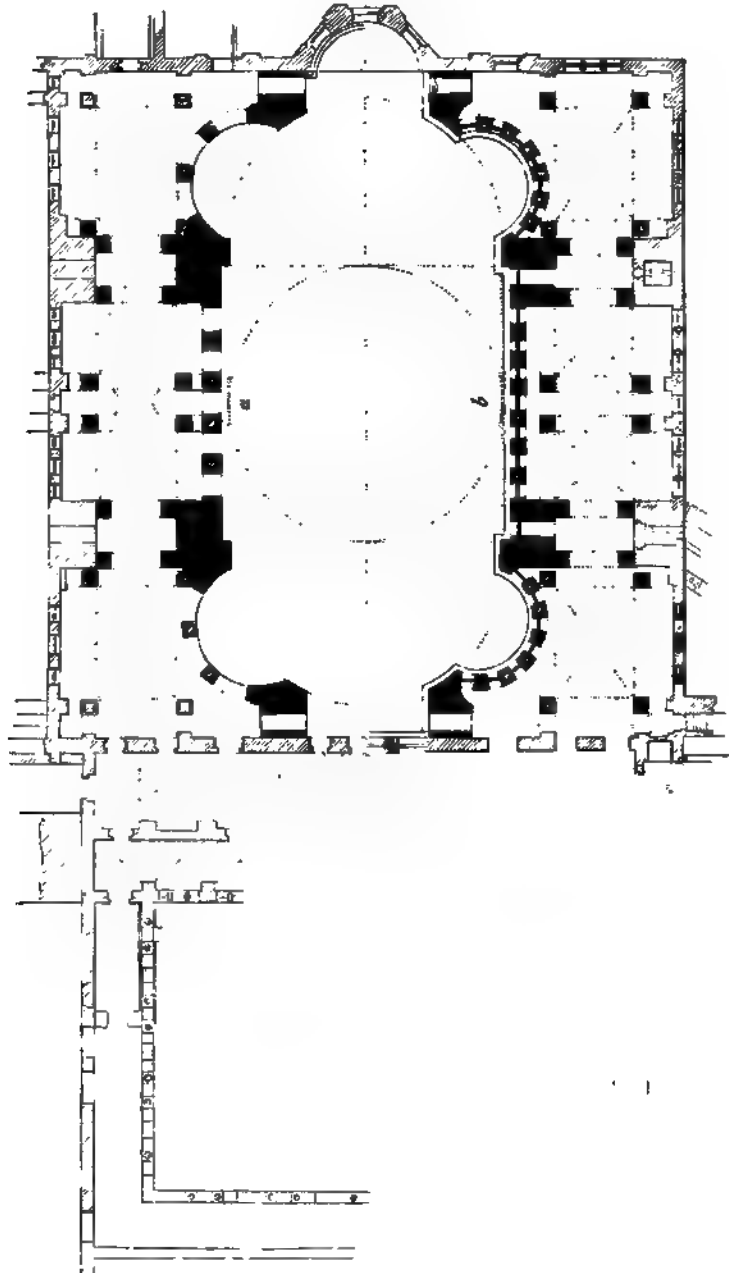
Grundriss (a Erdgeschoss, b Emporen) der Sophienkirche in Konstantinopel
